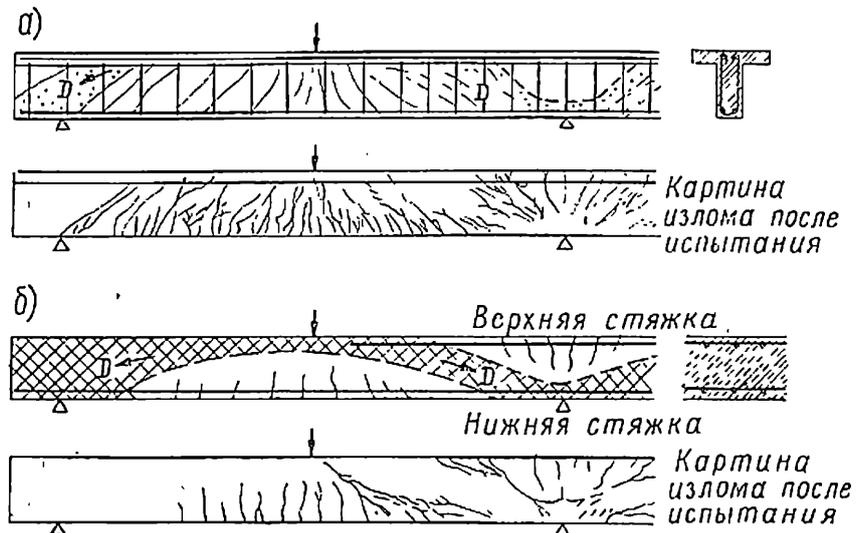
I.10. Воздействие нагрузки на неразрезные балки
